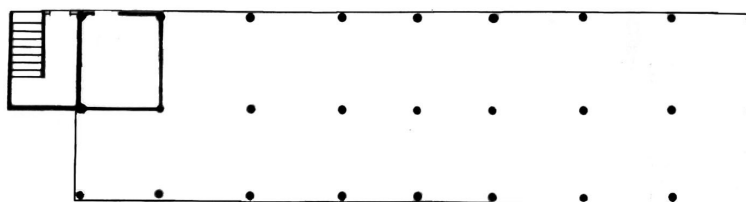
Planta do pavimento tipo do edifício com tipologia I2. Fonte: arquivo INSS.
